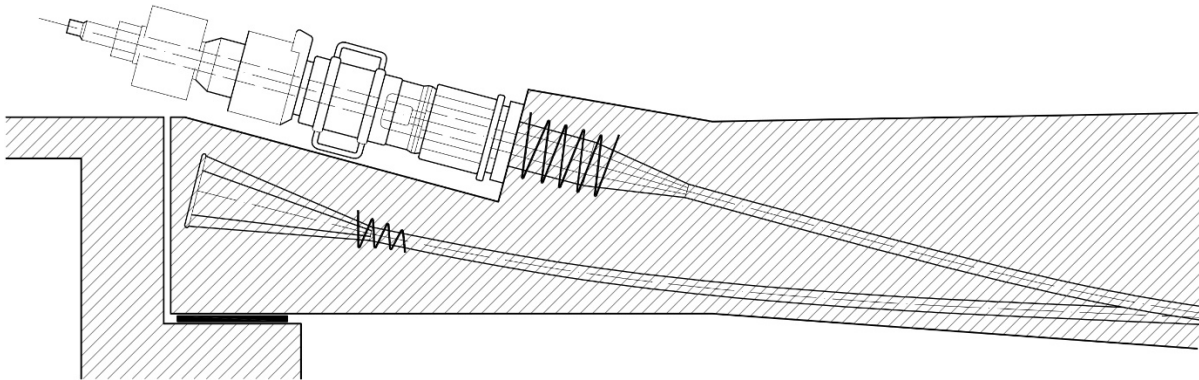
Conjunto Rioja. Detalle estructural típico de los puentes. Elaboración del autor.
